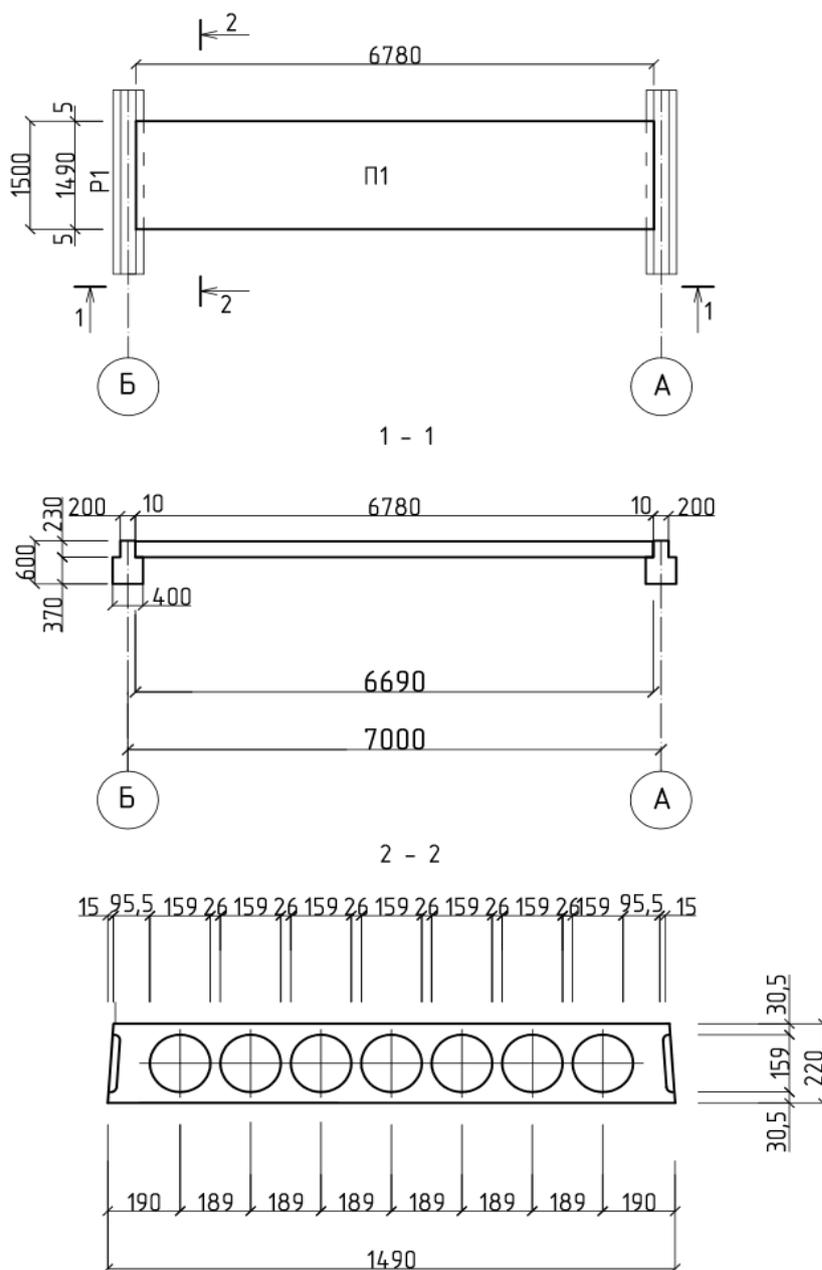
Многопустотная предварительно - напряженная плита перекрытия
